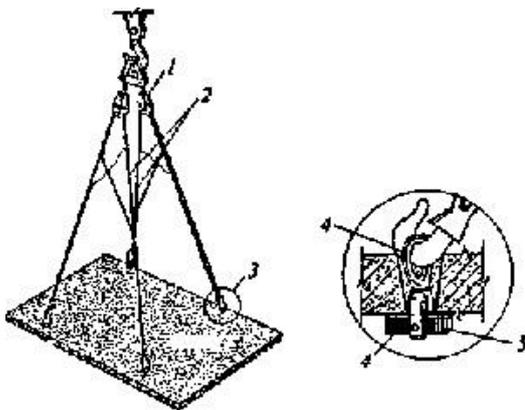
Стропування панелі перекриття: 1 – універсальна траверса;
